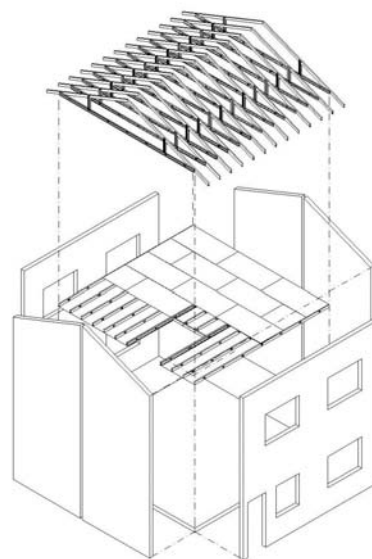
Esquema de construcción tipo “balloon” (de pisos múltiples). (Fuente: SCI).
